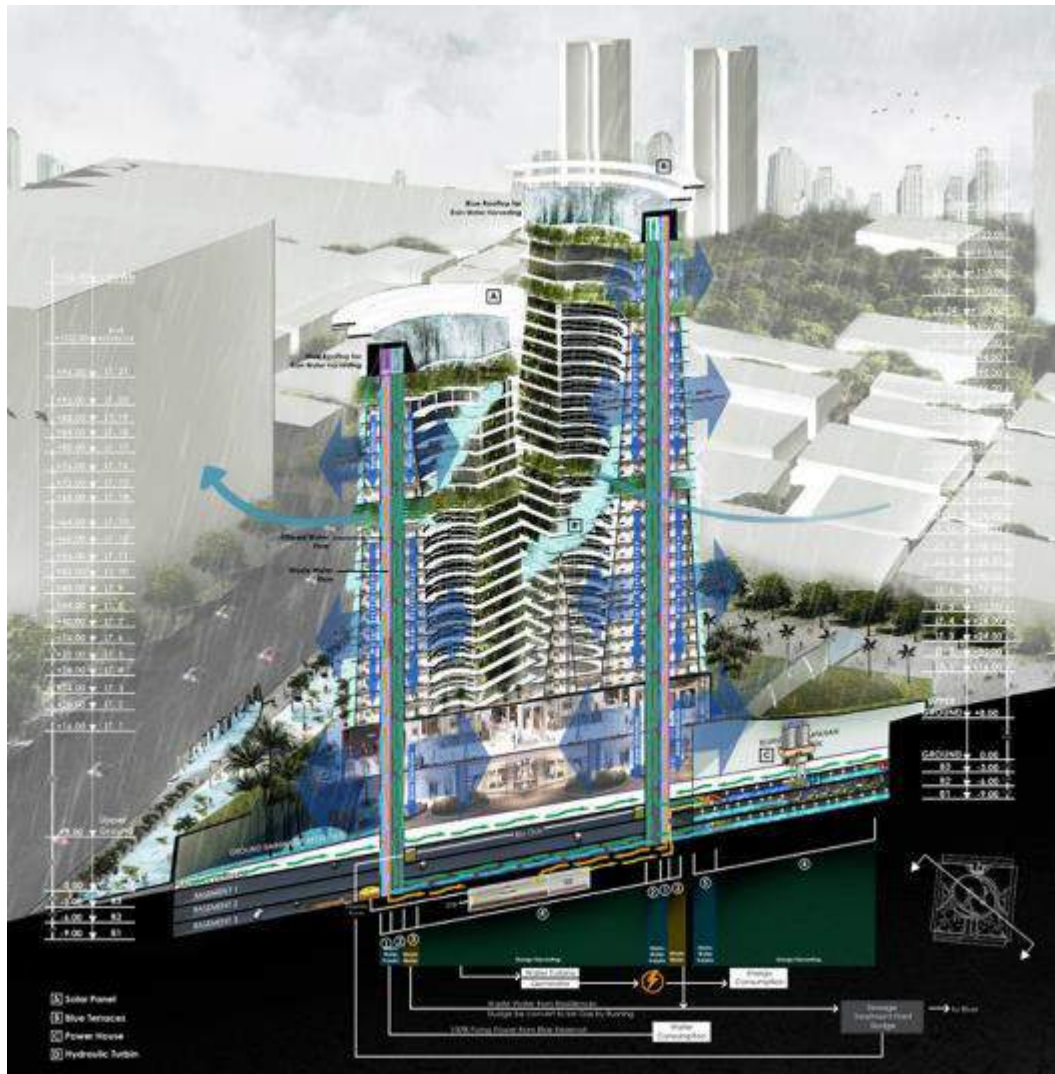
Penjelasan Struktur pada Tower Apartemen.
